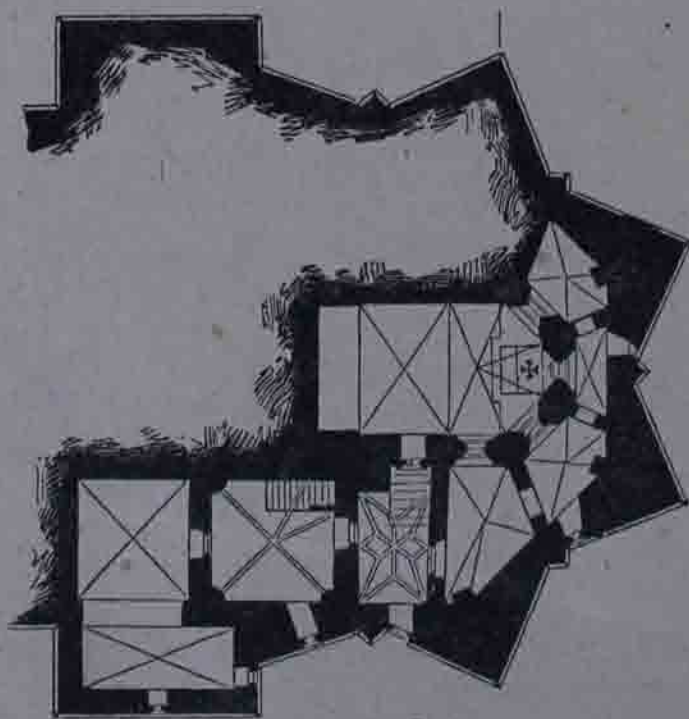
, Mödling, Otmarskirche; Grundriß der Unterkirche.
